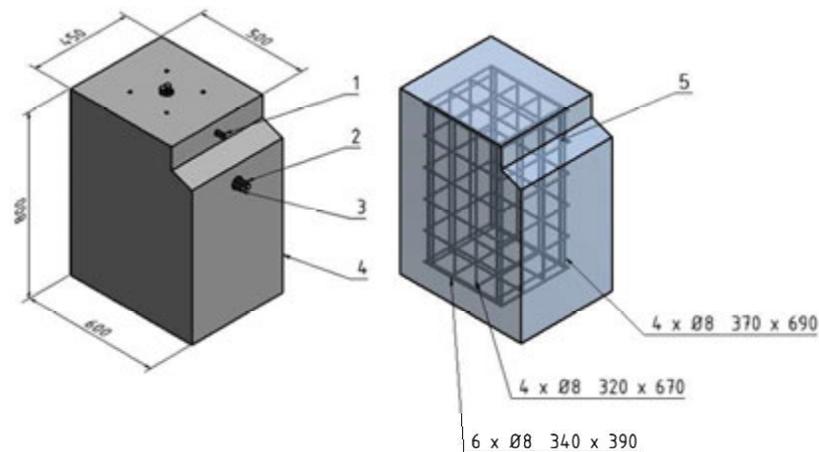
Fondations avec treillis d'armature (dimensions en mm)
